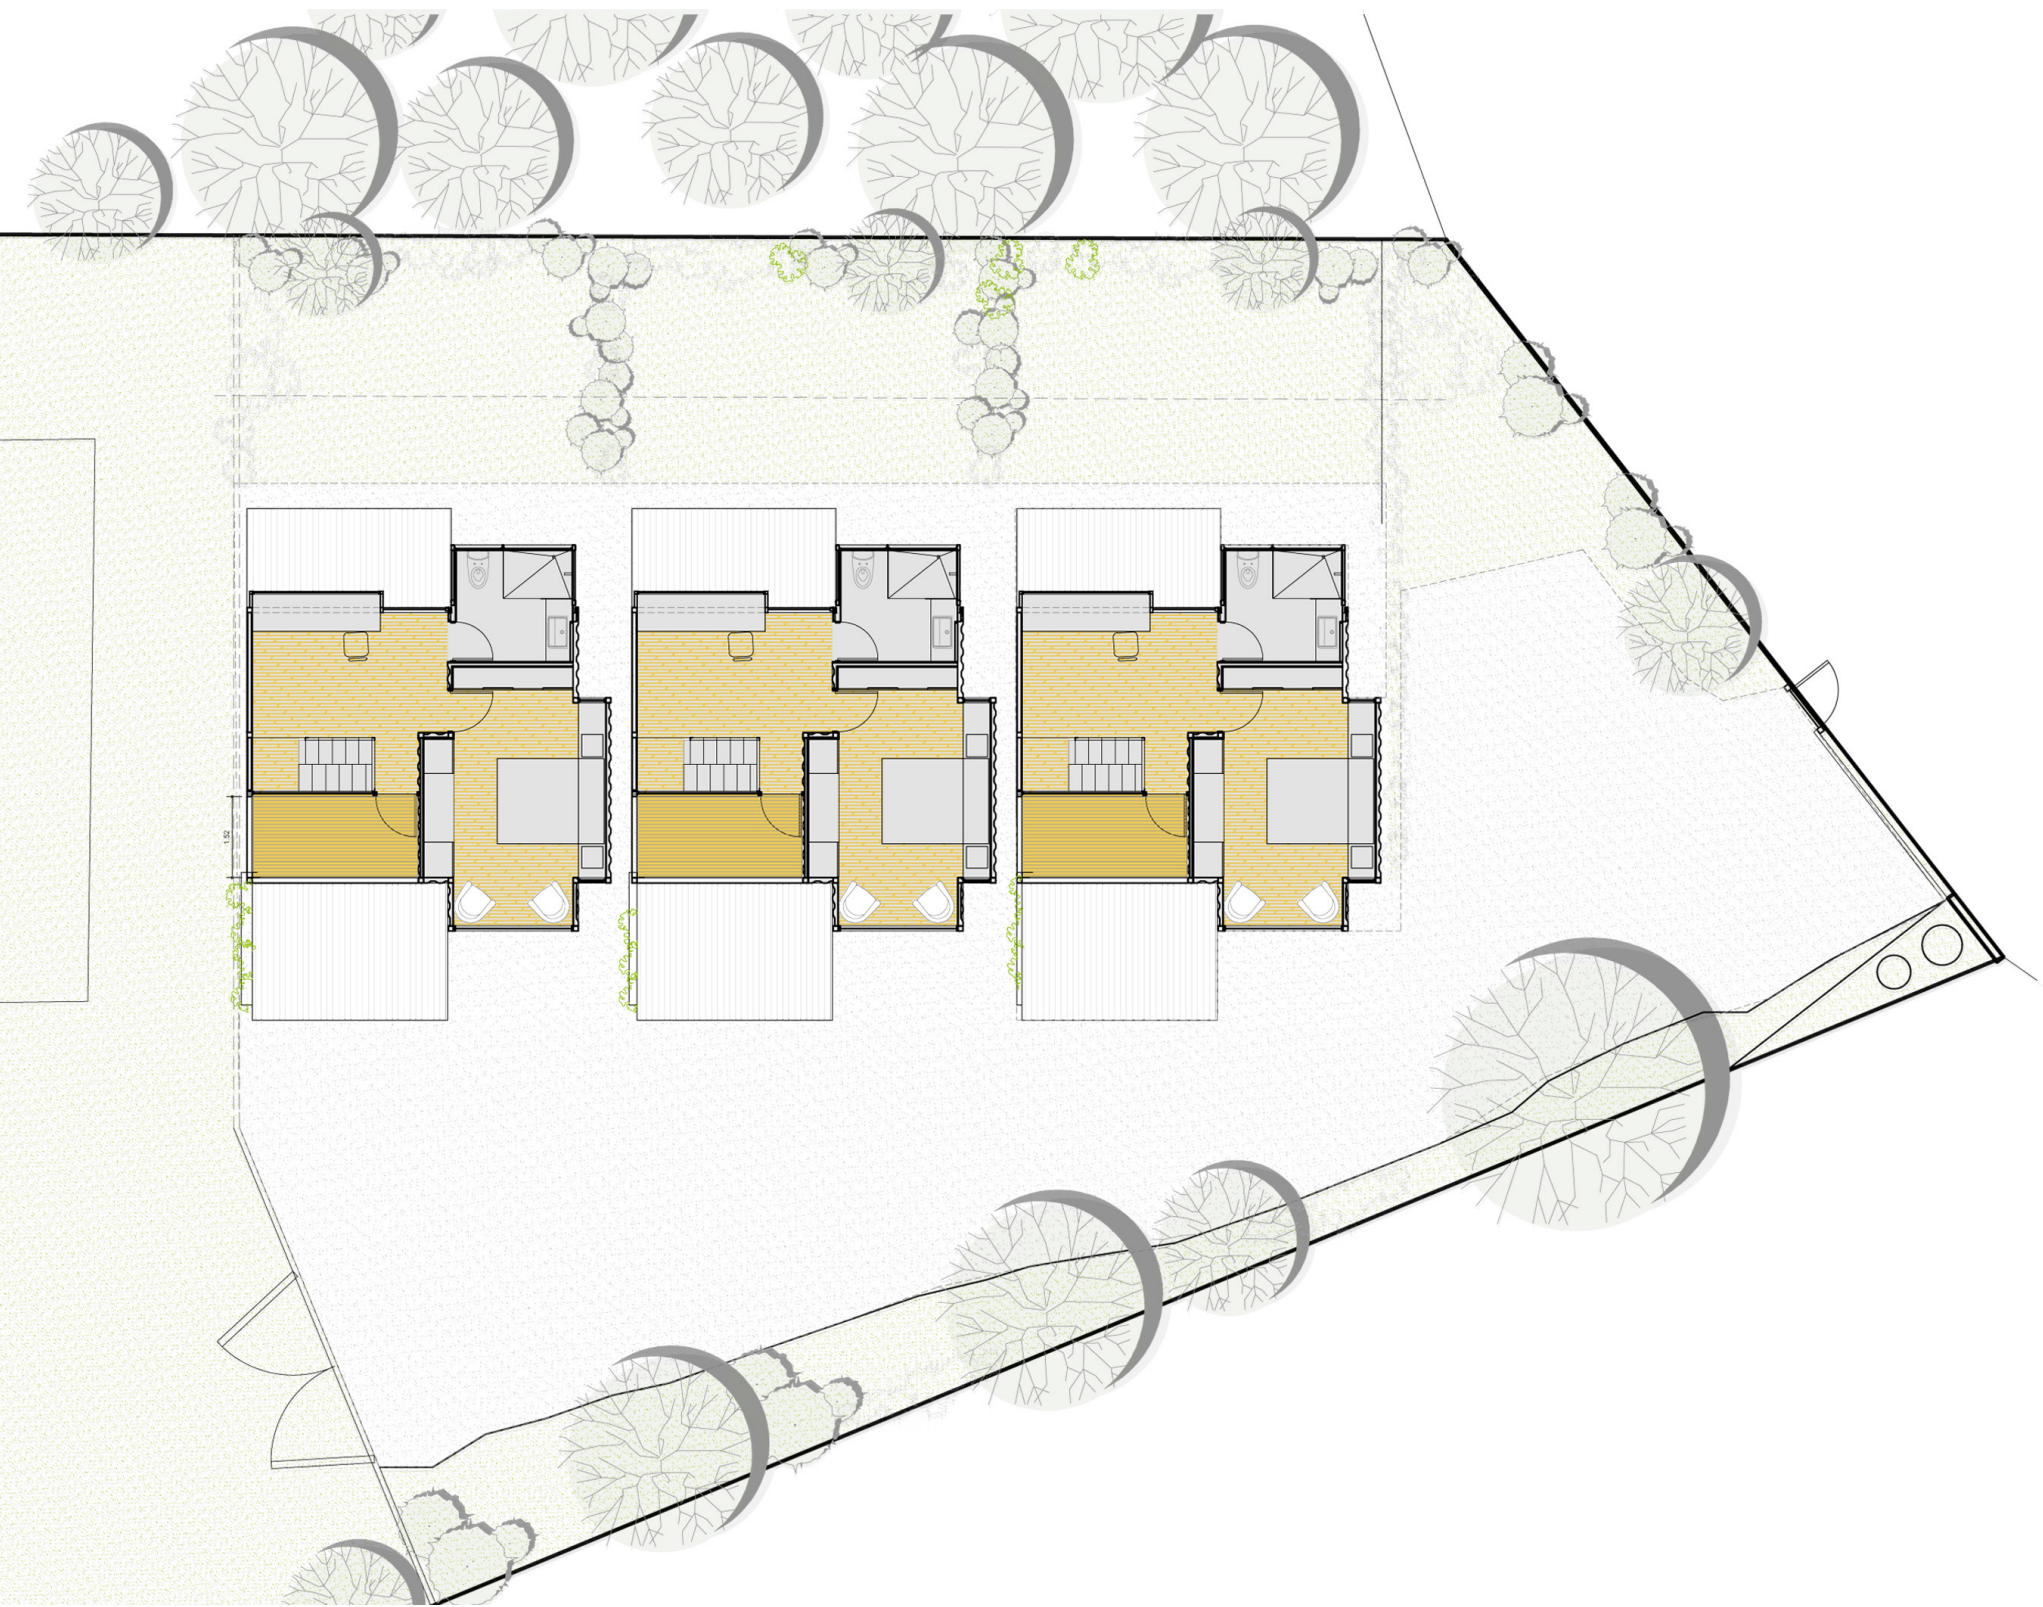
Planta de conjunto. Distribución arquitectónica. Primer nivel. ▲
